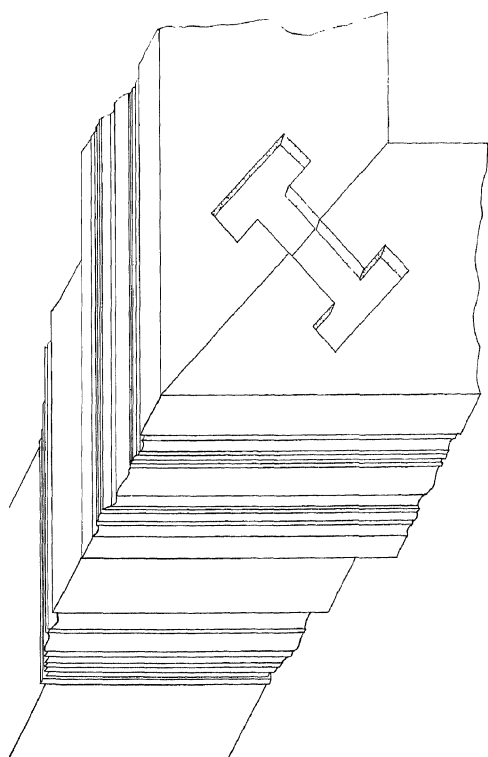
Logement d'un crampon sur un angle d'architrave.
